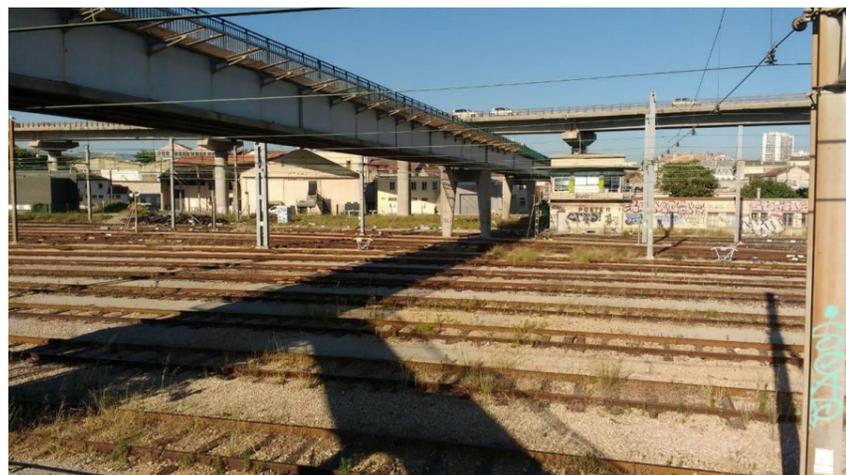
Vue d'ensemble de la passerelle piéton (source : Arcadis)
